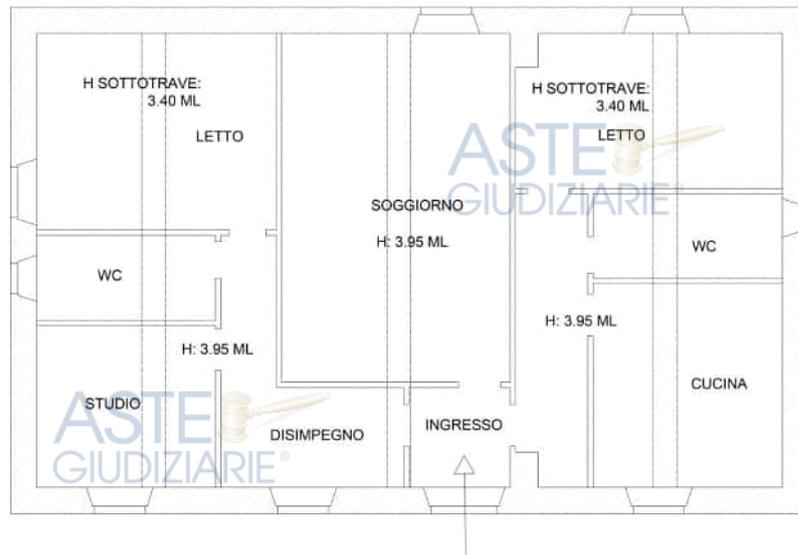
Planimetria stato reale e rilevato Piano Terra Subalterno 1
